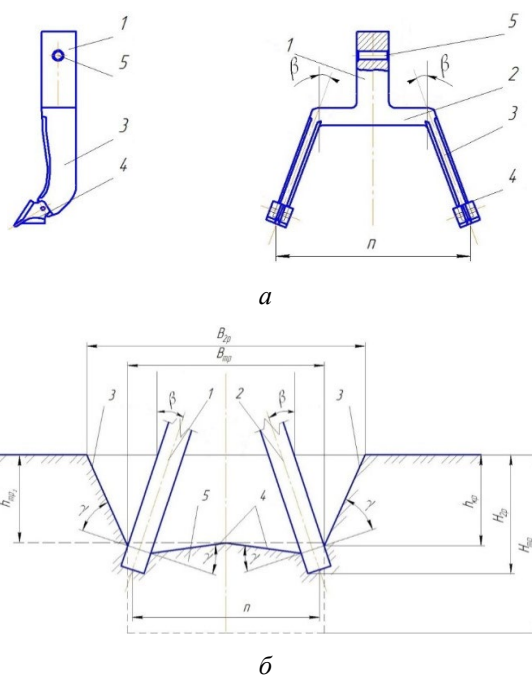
Розробка ґрунтів розпушником із зубцями з нахилом: а – робочий орган: 1 – стійка; 2 – консоль; 3 – зубці; 4 – наконечник; 5 – отвір кріплення; б – схема розробки ґрунтів: 1, 2 – зубці; 3 – бокові поверхні прорізи; 4 – внутрішні поверхні прорізи; 5 – нерозпушена зона
